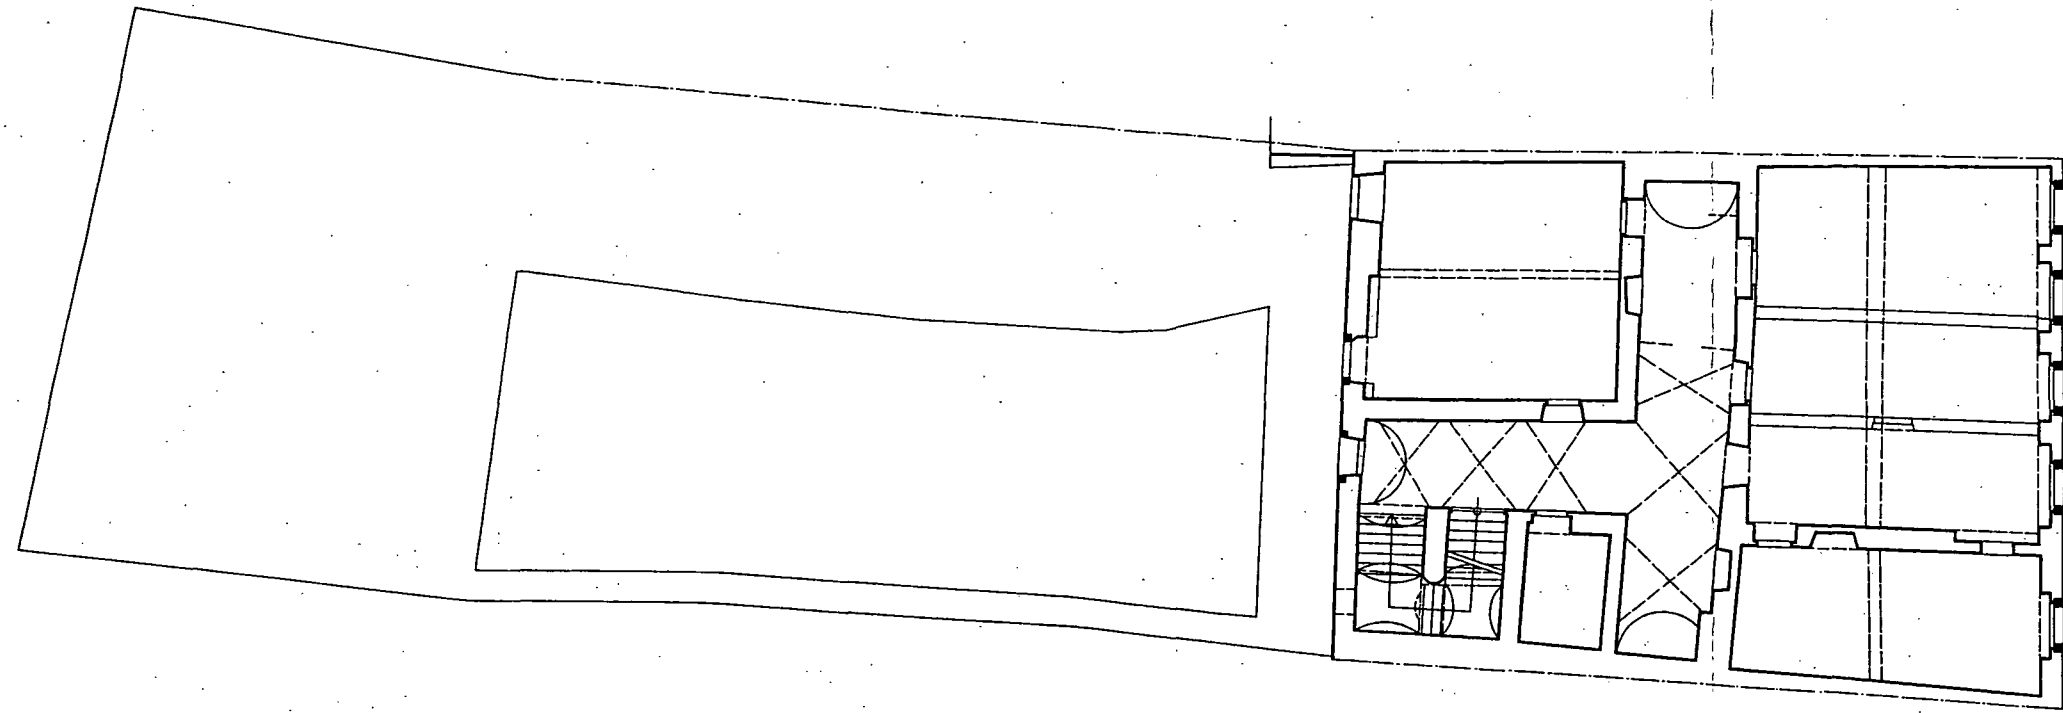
Stadtplatz 29 – Grundrisse 1. und 2. Obergeschoss (1:200).
